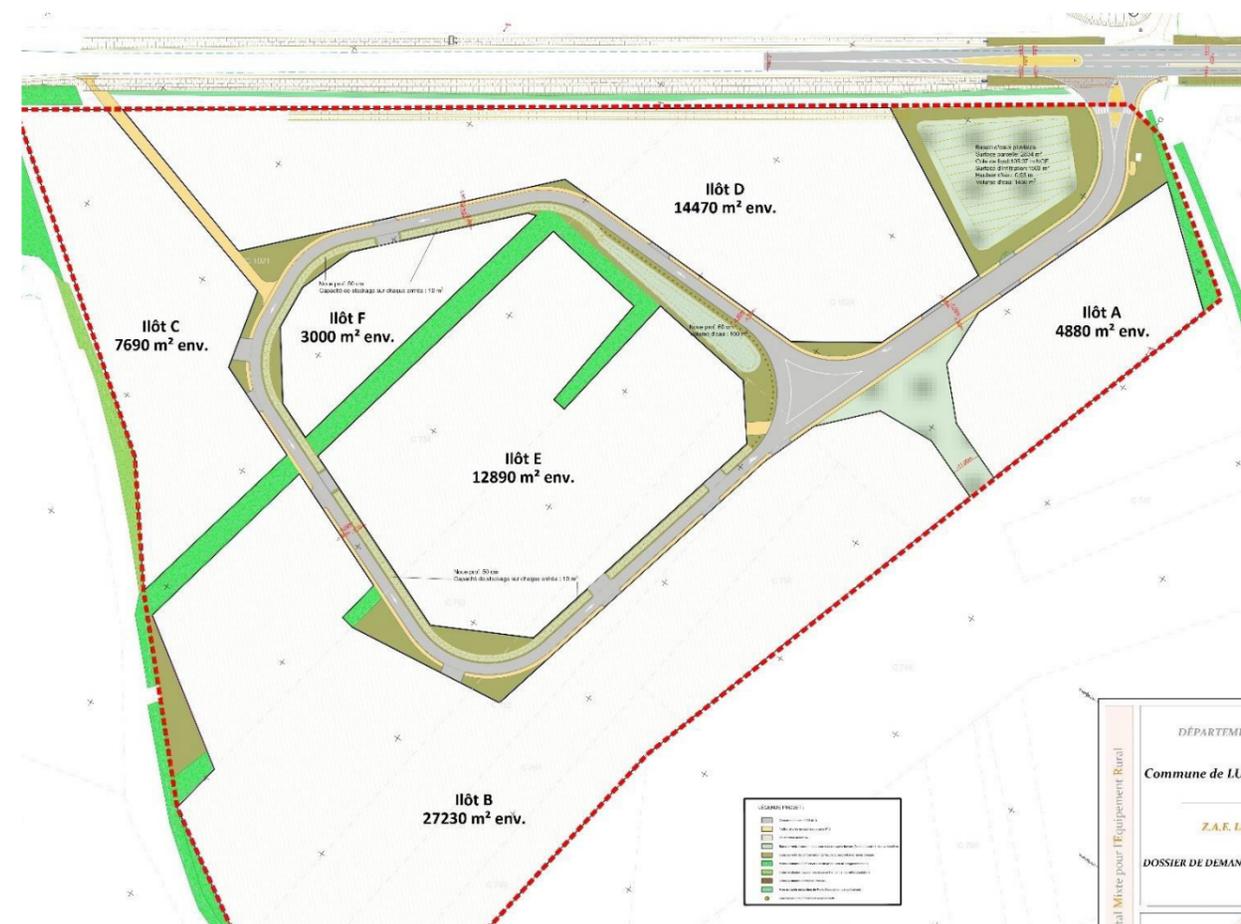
plan d'aménagement de la zone, variante 4, plan final
